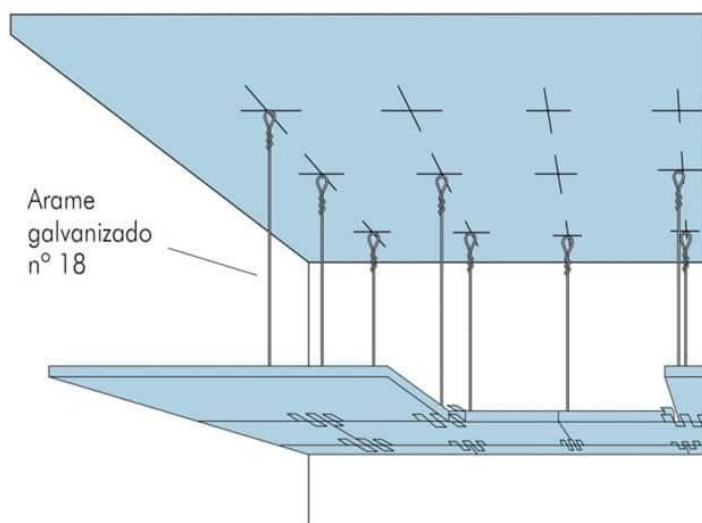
Sistema de fixação de forro de gesso acartonado utilizado
